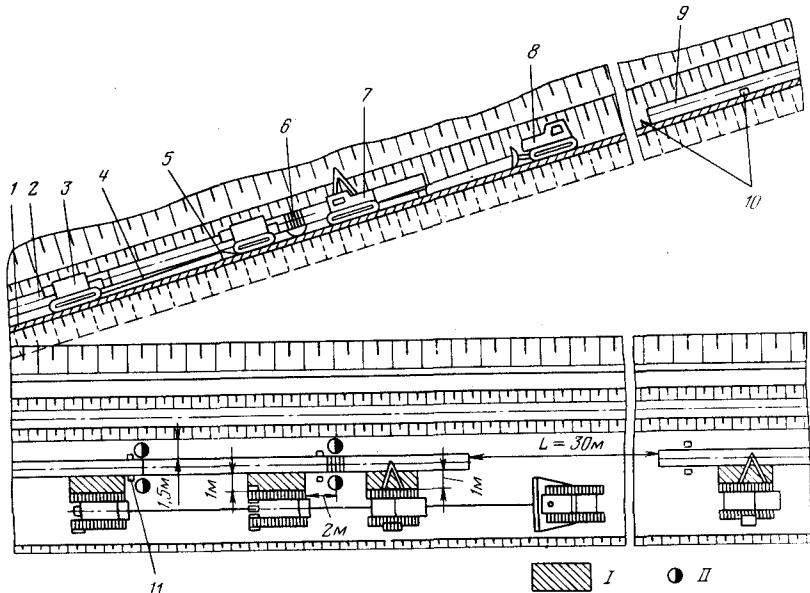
Схема производства сварочно-монтажных работ на склонах крутизной от 15 до 18° :
